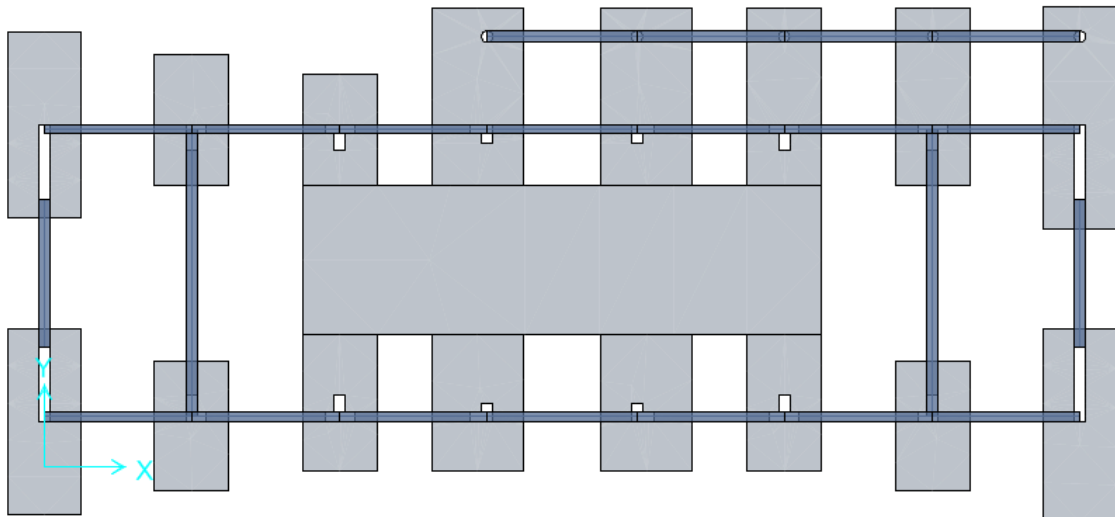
Vista en planta, modelo de la cimentación, con base convencional del “POOL DE AULAS – POOL A”.
